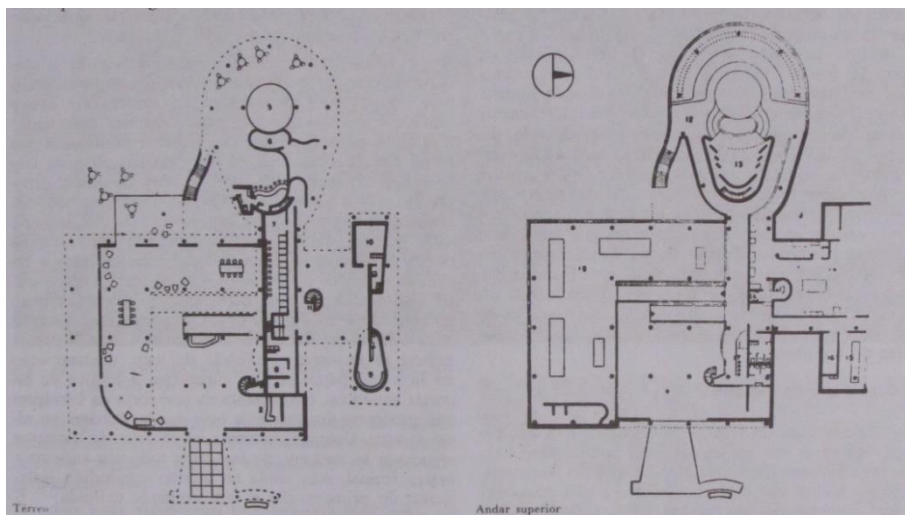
Plantas Baixas do Cassino da Pampulha
